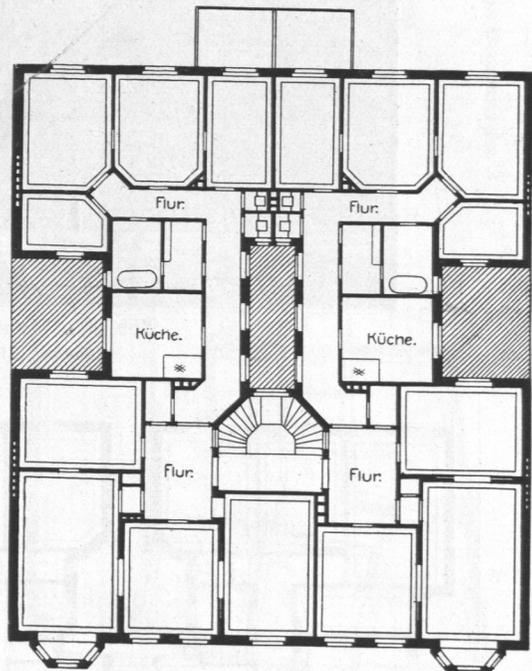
Haus Hartwicusstraße Nr. 2, Obergeschoß.
